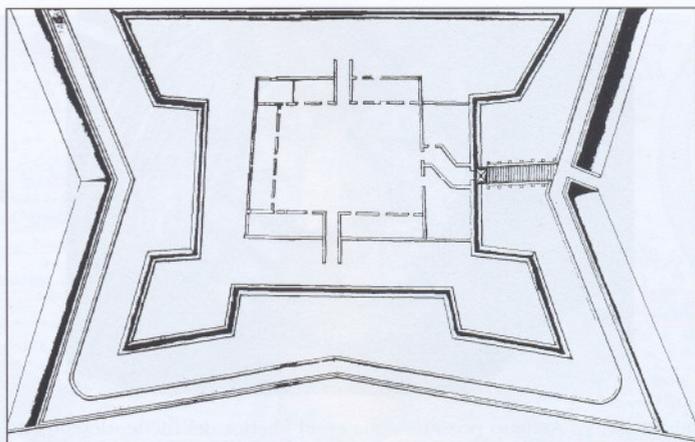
Planta del Forte Brum en el siglo XVIII.
